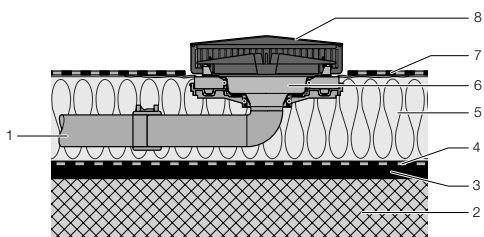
Конструкция монолитной кровли, изолированной, горизонтальный излив в тепловой изоляции, с кровельным покрытием и пароизоляцией
